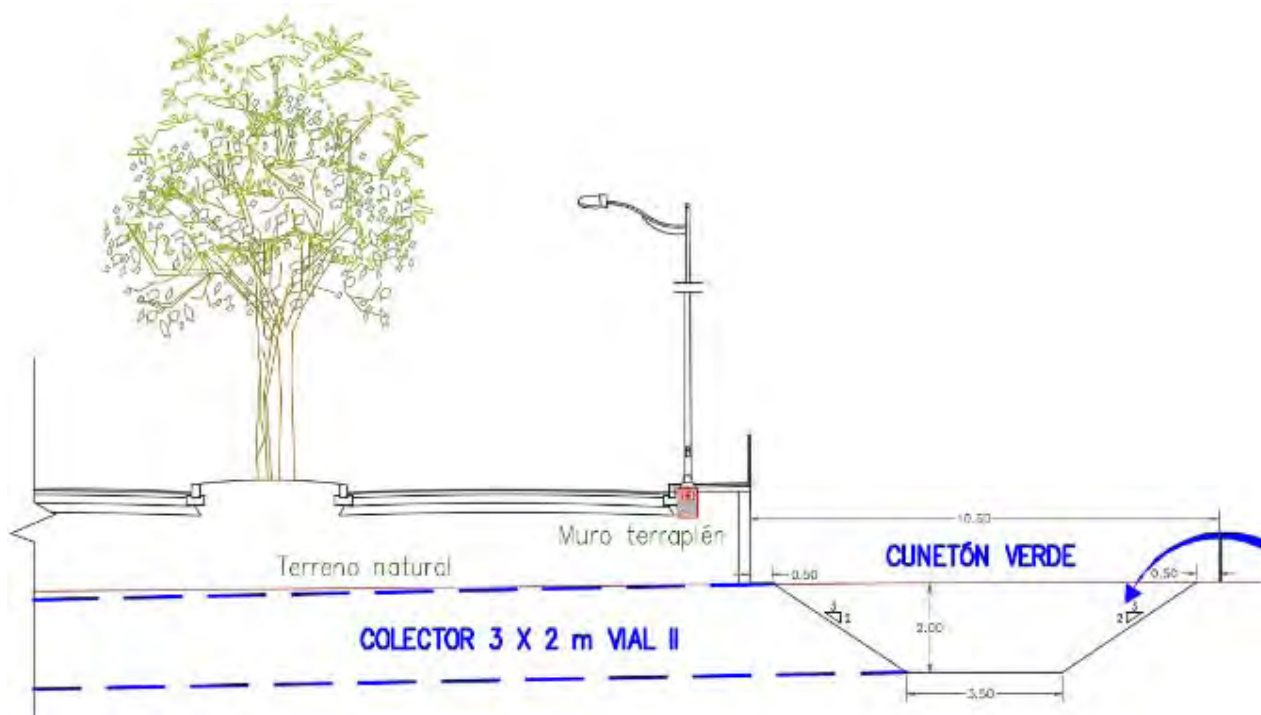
Perfil transversal del vial V con cunetón verde perimetral y marco de 3 x 2 de desagüe
